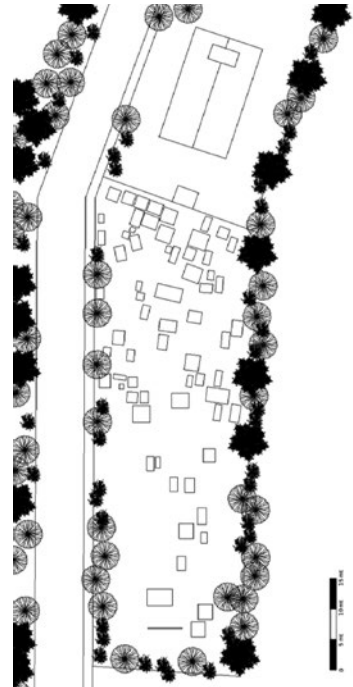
Planta general cementerio de Teupa, Chiloé. Levantamiento y dibujo: Victoria Cárdenas Oberreuter.
